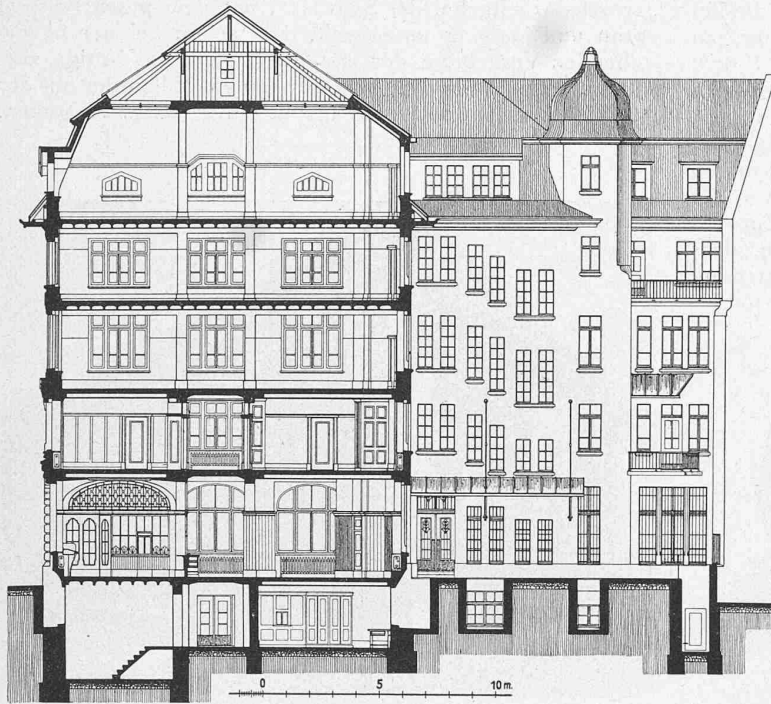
Schnitt senkrecht zur Brandschenkestrasse, und Hoffassade. — 1 : 250.
